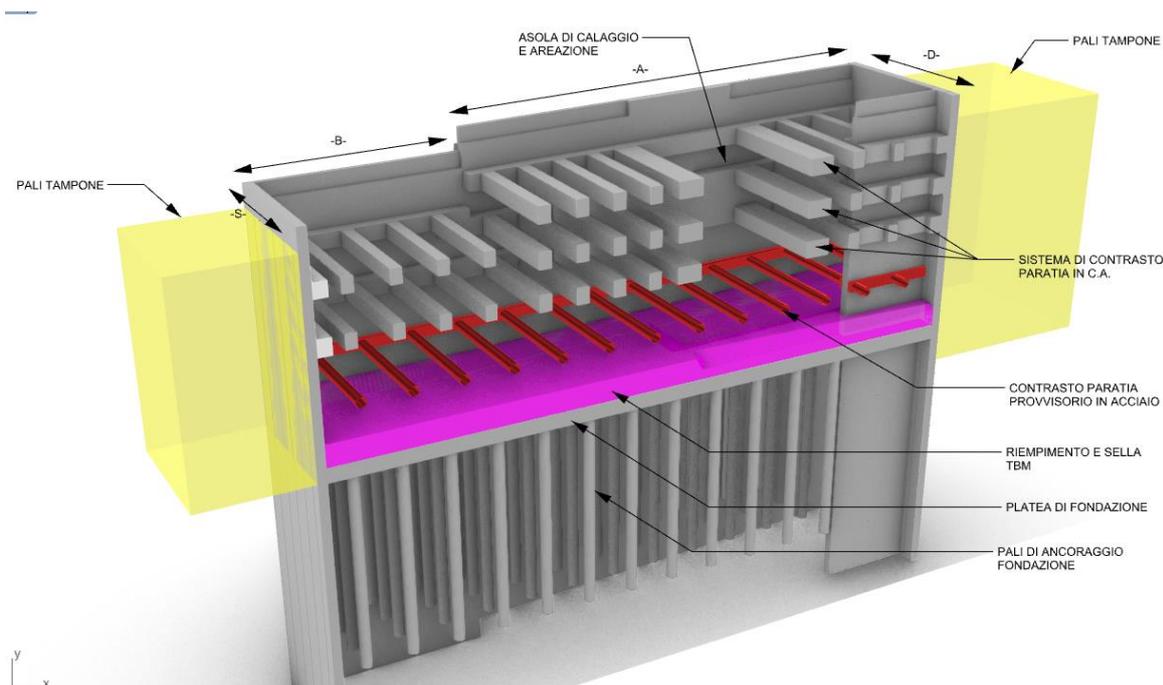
Pozzo lancio TBM - Strutture in fase di cantiere
